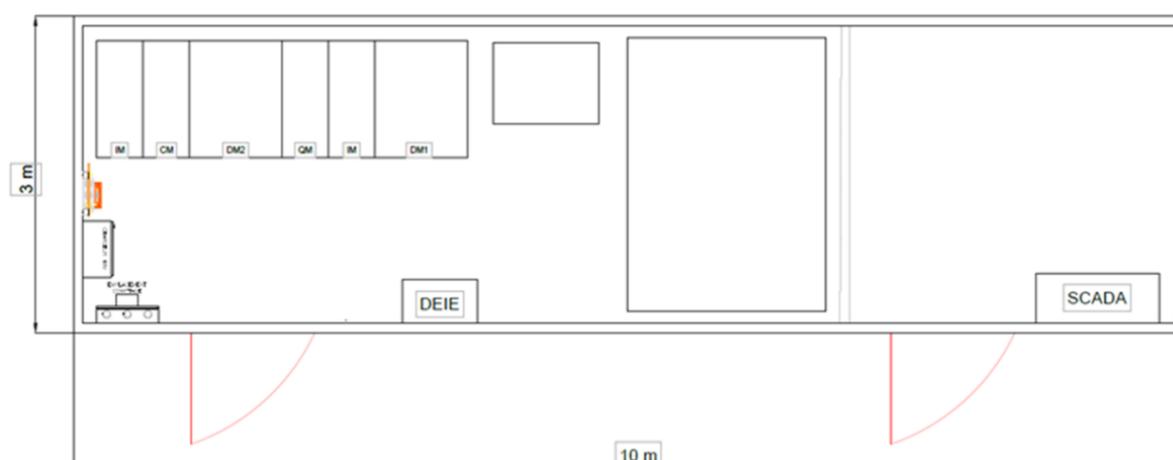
Exemple de plan de masse du poste de livraison (Source : VALECO)
